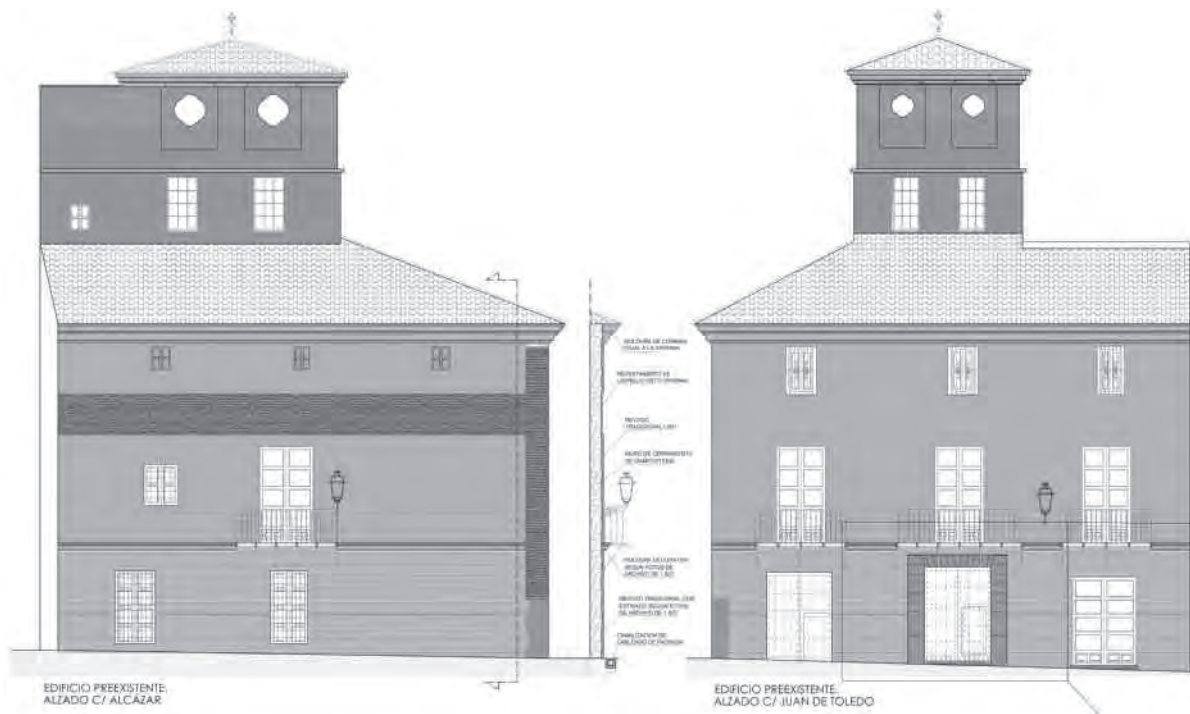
Alzados de la solución propuesta para la fachada en el proyecto de rehabilitación.
